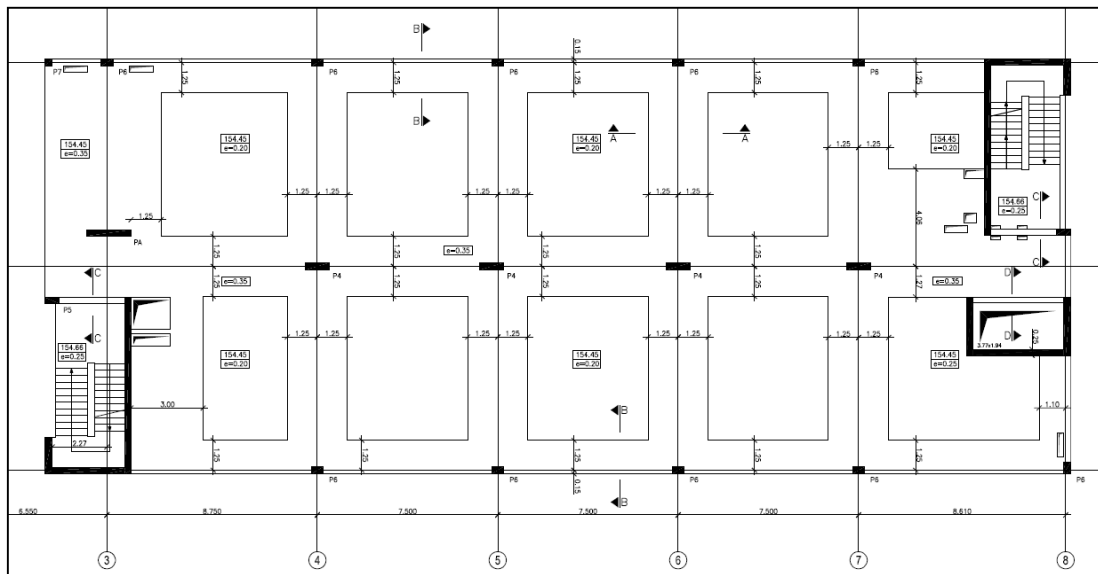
Planta tipo dos pisos superiores do edifício em estudo
